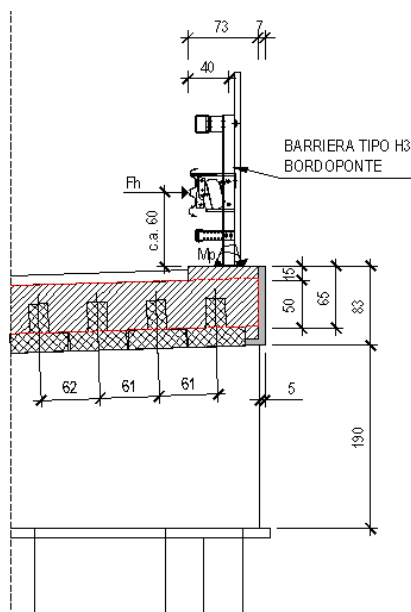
Schema dell'azione d'urto contro la barriera.
